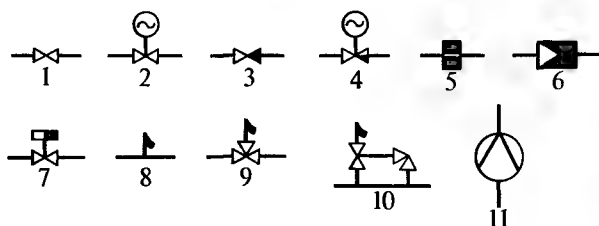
Условные обозначения арматуры на схемах трубопроводов:
